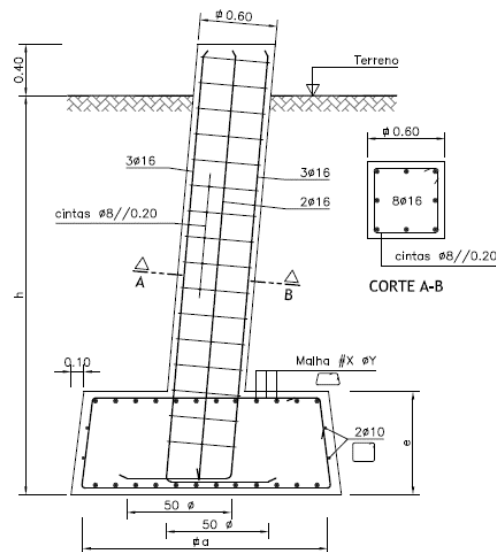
Esquema do maciço de fundação dos apoios.
